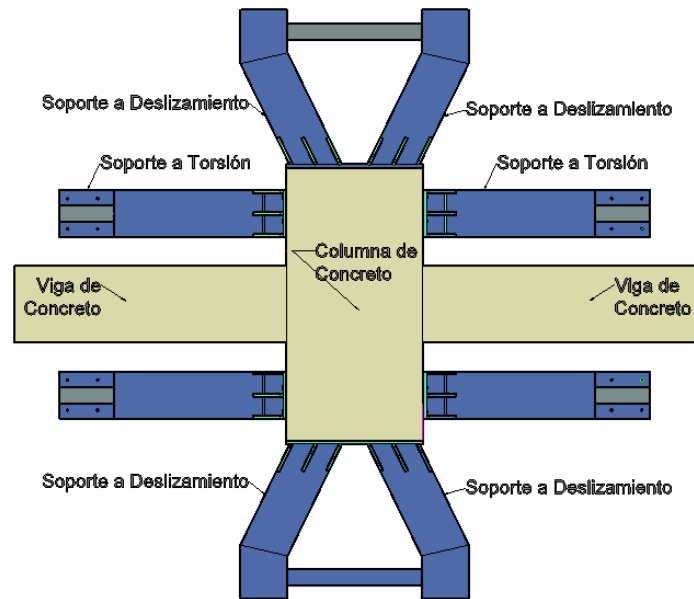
Estructura de apoyo para resistir el movimiento de la columna
